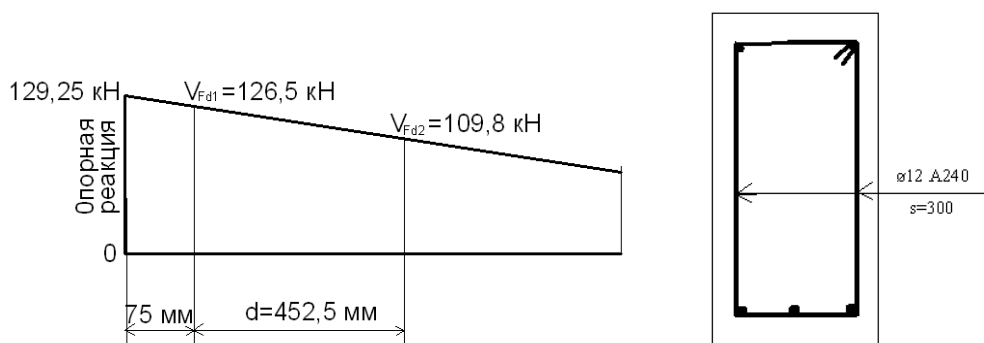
Схема положения расчетного сечения по поперечной силе
